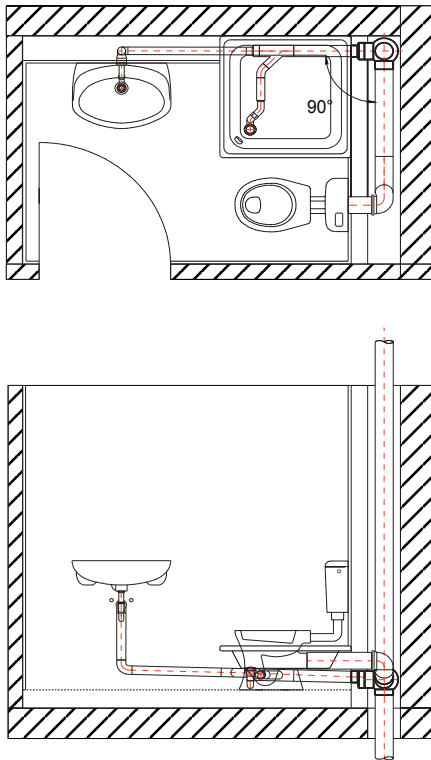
Zweieilige Installation: überspülungs-sichere Anschlussleitungen durch Verwendung eines Kugelabzweigs
